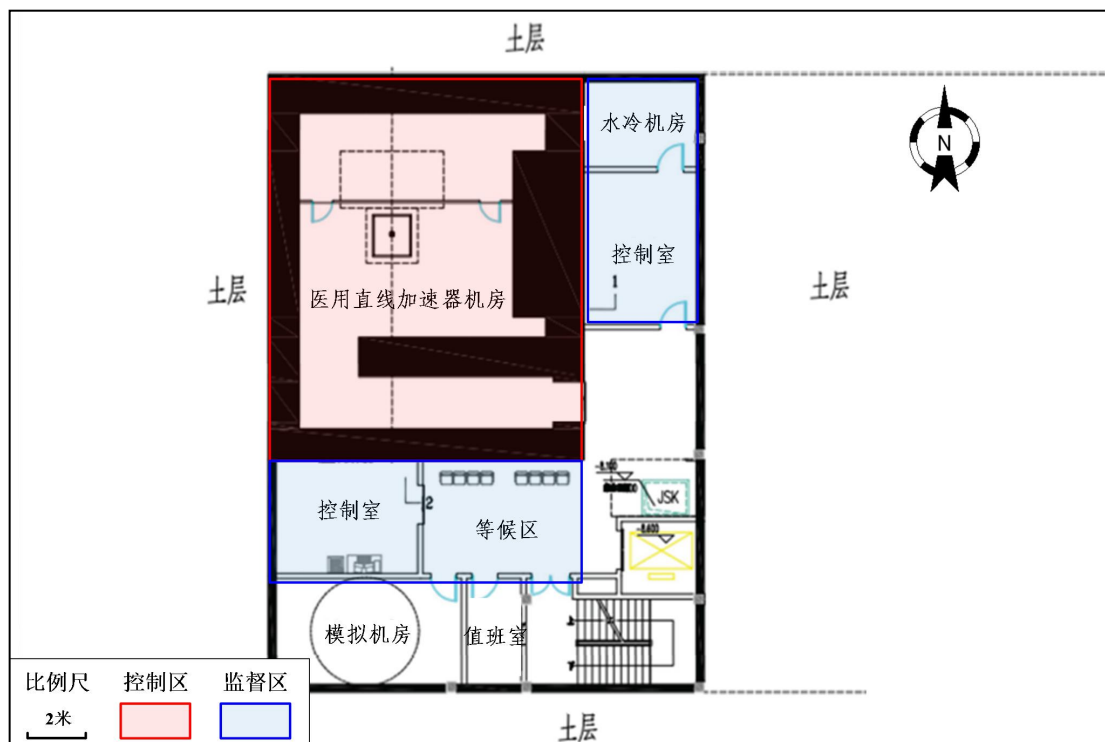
本项目医用直线加速器机房平面布置及分区示意图
